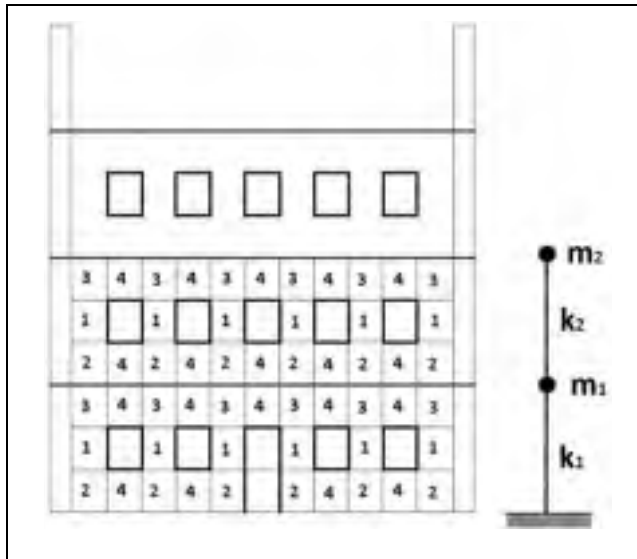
Représentation de la modélisation dans le plan des murs de façade
